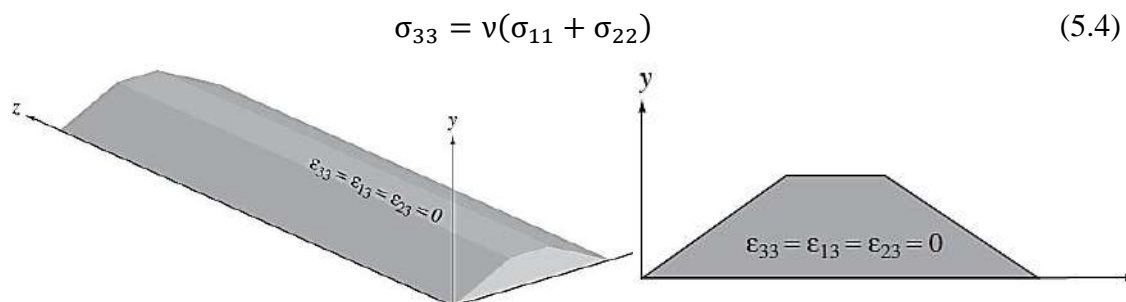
Estrutura tridimensional de um pavimento apresentado em um estado plano de deformações
